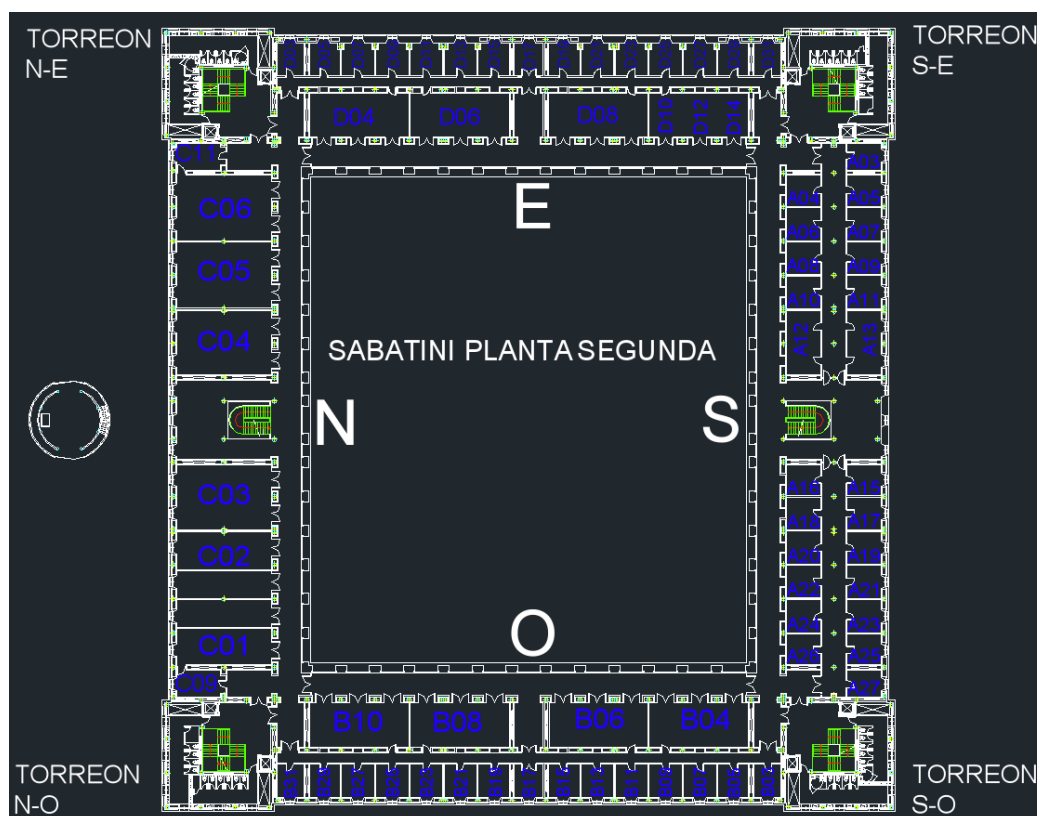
Vista en planta de la planta segunda, edificio Sabatini – AutoCAD
